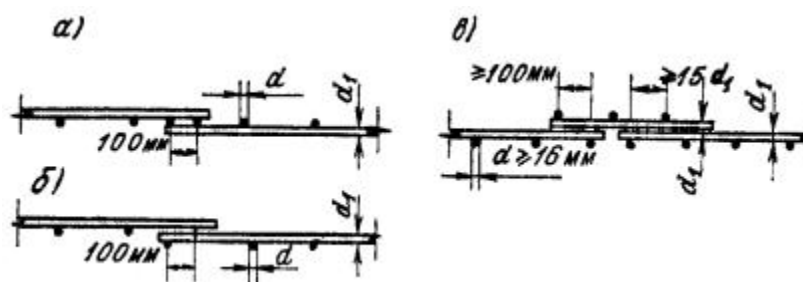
Стыки сварных сеток в направлении распределительной арматуры
